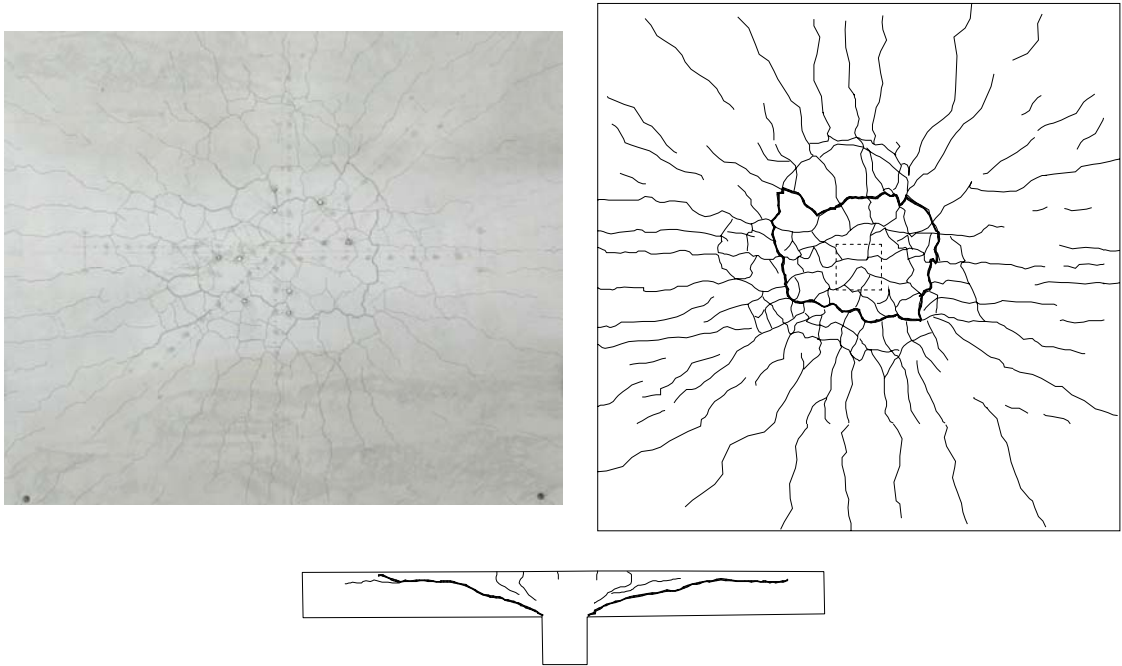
PG-1 : Fissures face supérieure (N en haut) et coupe NS
